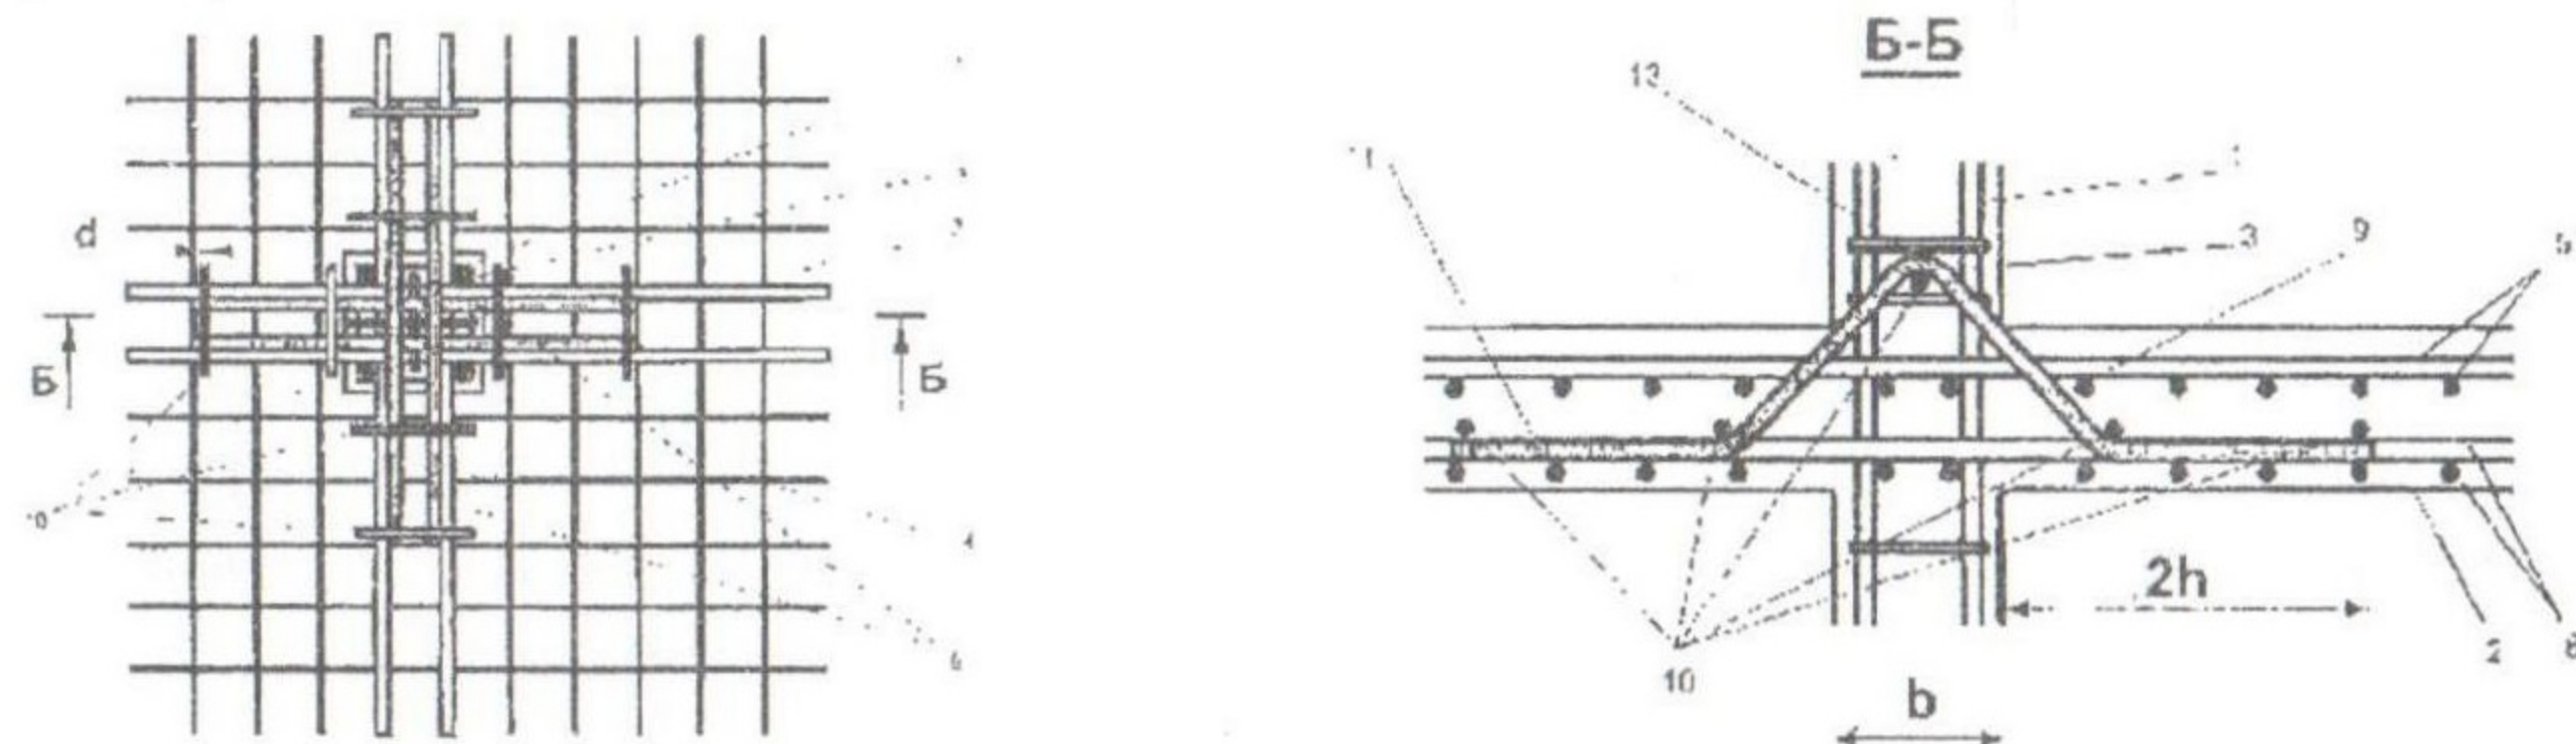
Узел соединения колонны с плитой перекрытия с использованием V-образных анкеров: 1 – колонна; 2 – плита перекрытия; 3 – арматурный каркас колонны; 4 – арматурный каркас плиты перекрытия; 5 – верхняя сетка; 6 – нижняя сетка; 9 – V-образные анкера
